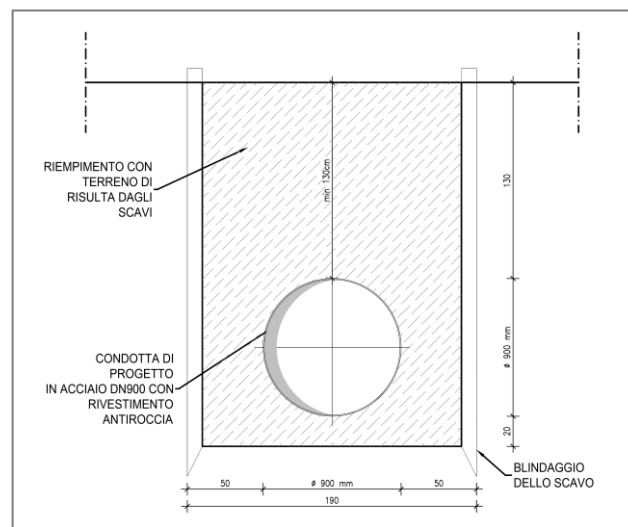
Sezione tipo di posa su area verde - stralcio 1.
